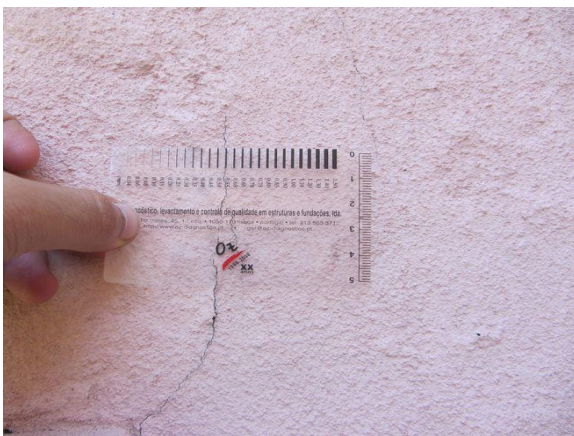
Medidor de fissuras - Fissura com 0,50mm de largura. Fonte: Autor, outubro 2017.
